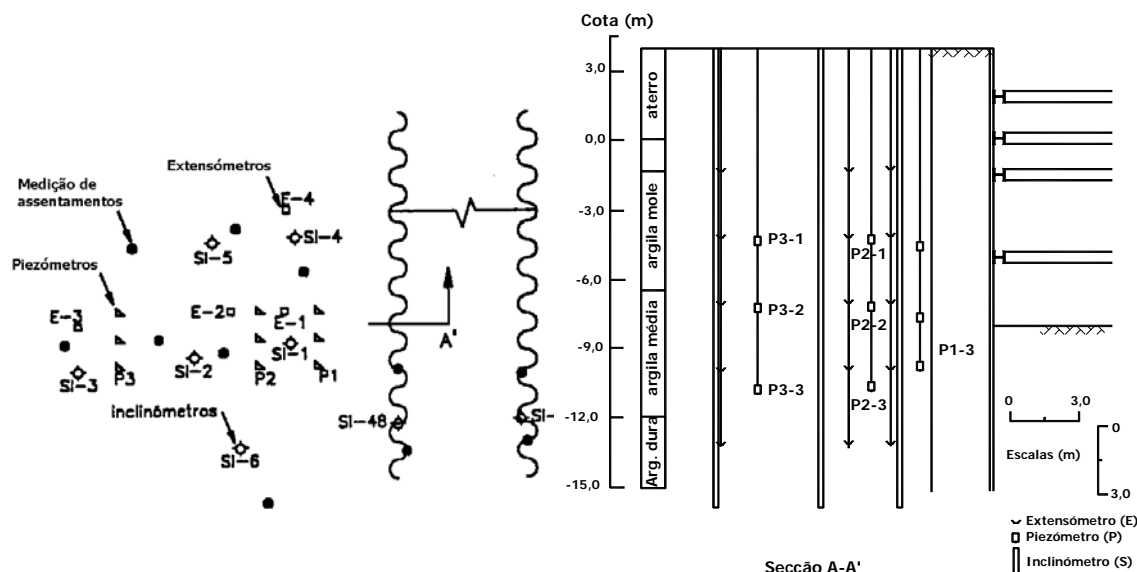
Planta de instrumentação e secção instrumentada da escavação HDR-4, Chicago (Finno et al., 1989)
